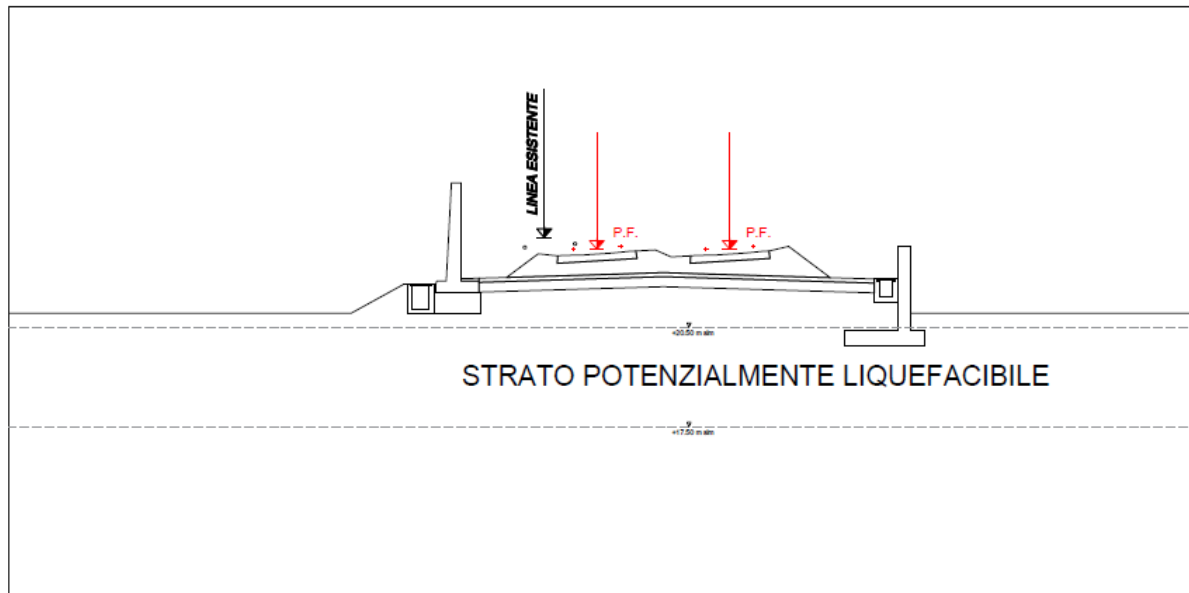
Sezione rilevato alla pk 6+150 su strato di terreno liquefacibile
